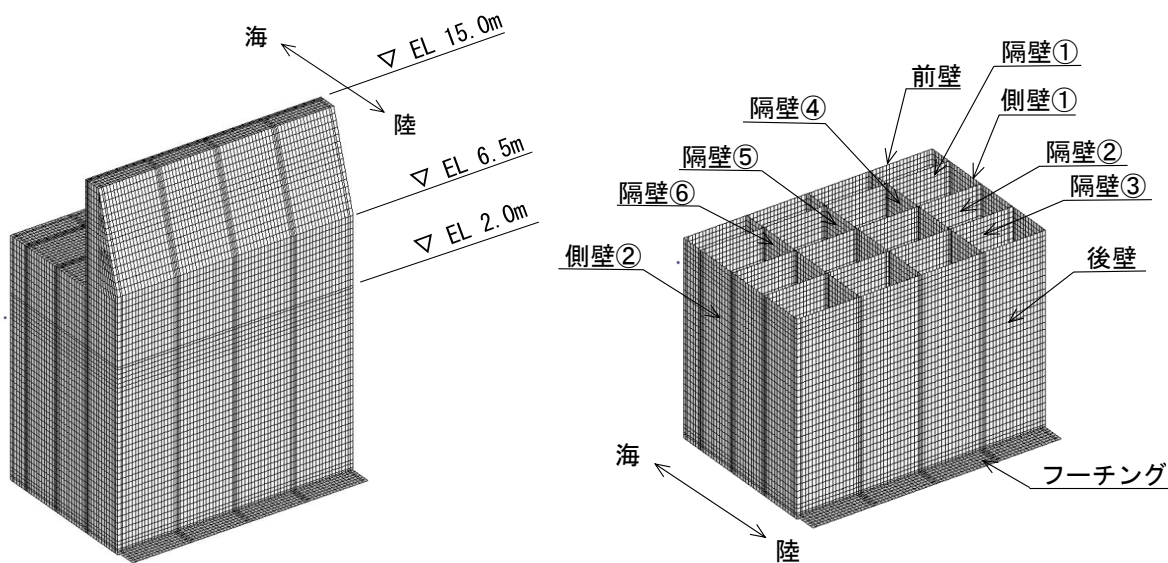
(1) 評価対象部材位置図 (②-②断面)
